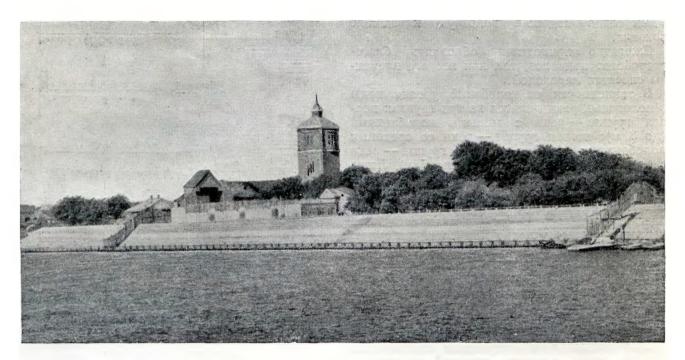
Астрахань. Укрепление берега железобетонными плитами
